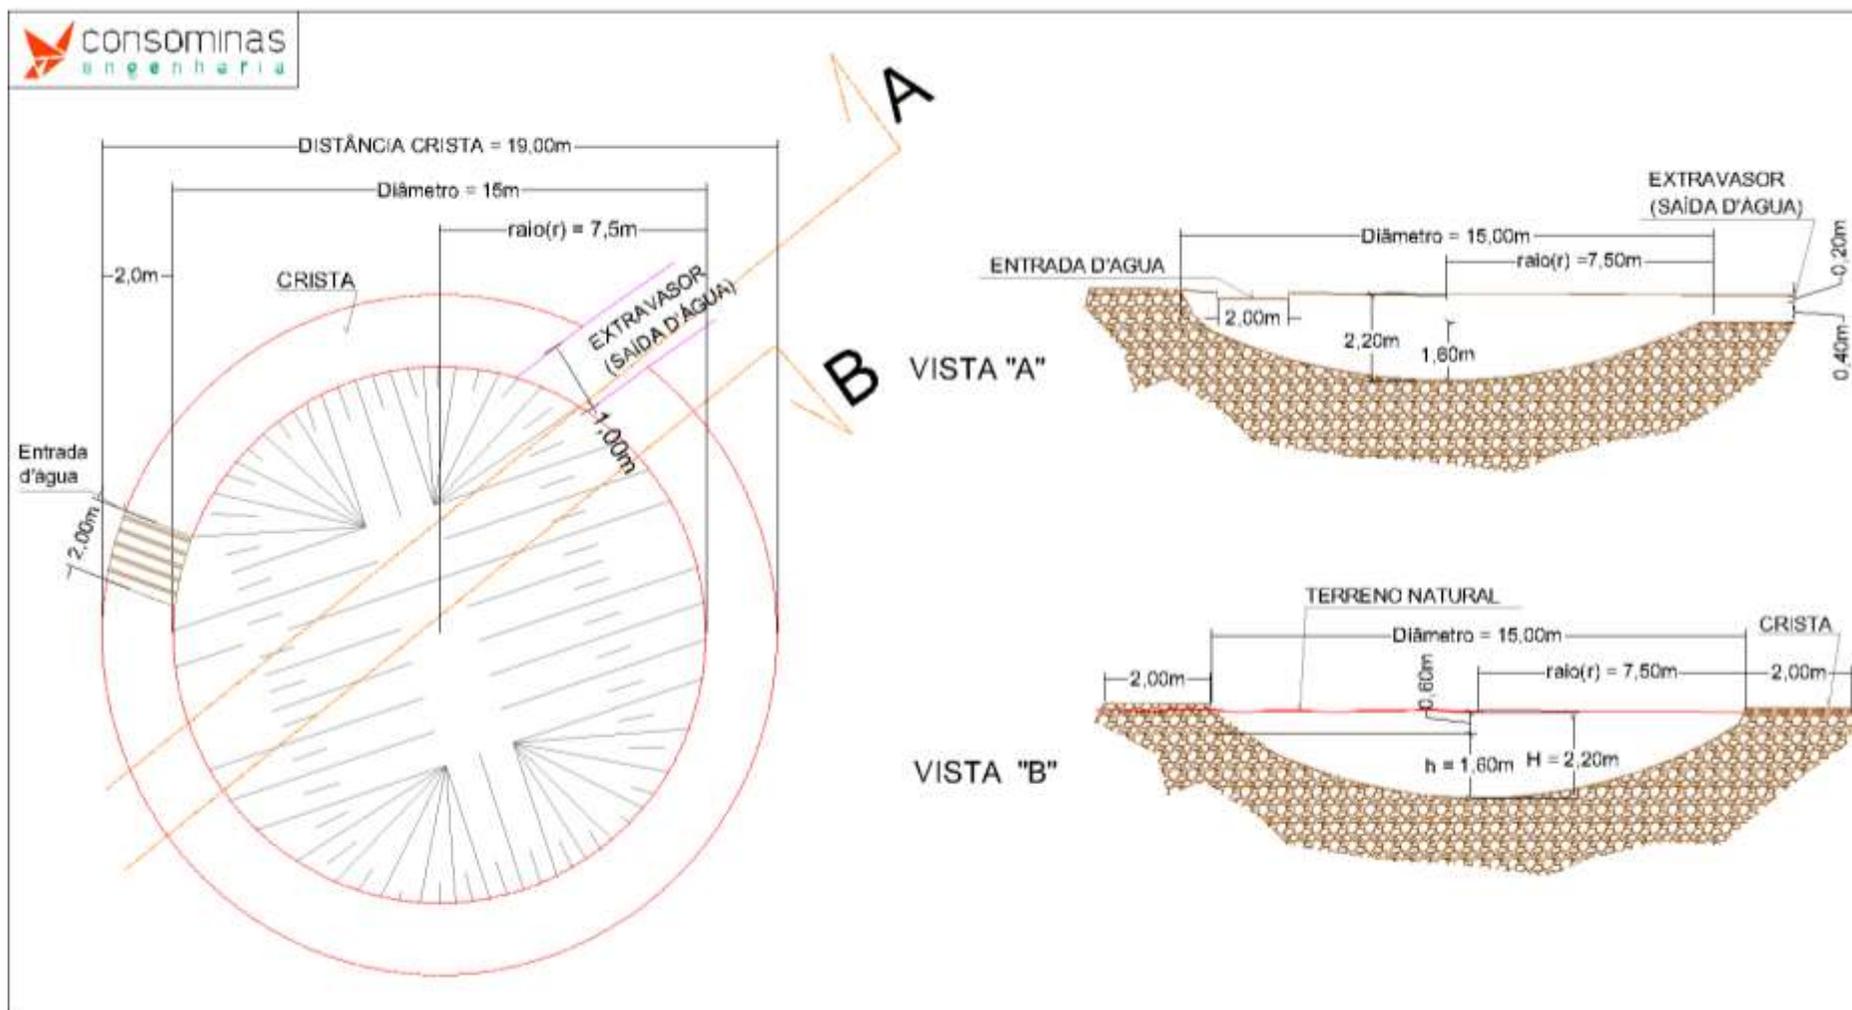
Planta e perfil de bacia de contenção do Tipo II.
